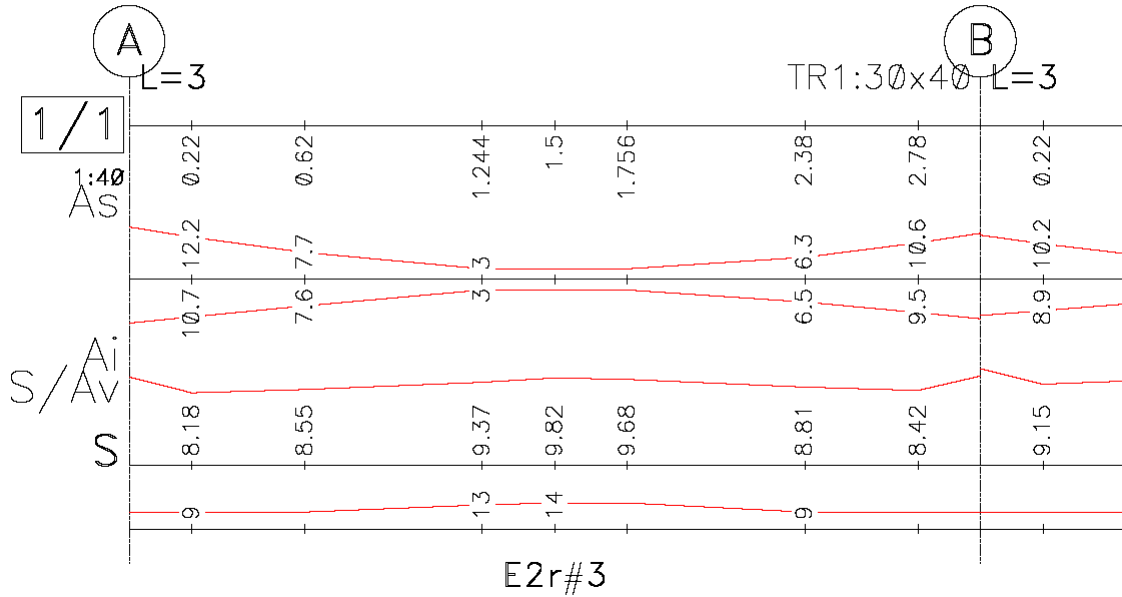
Detalle de aceros de refuerzo para el tramo A-B de la viga del eje 1 del primer nivel en el edificio de 7 niveles.
